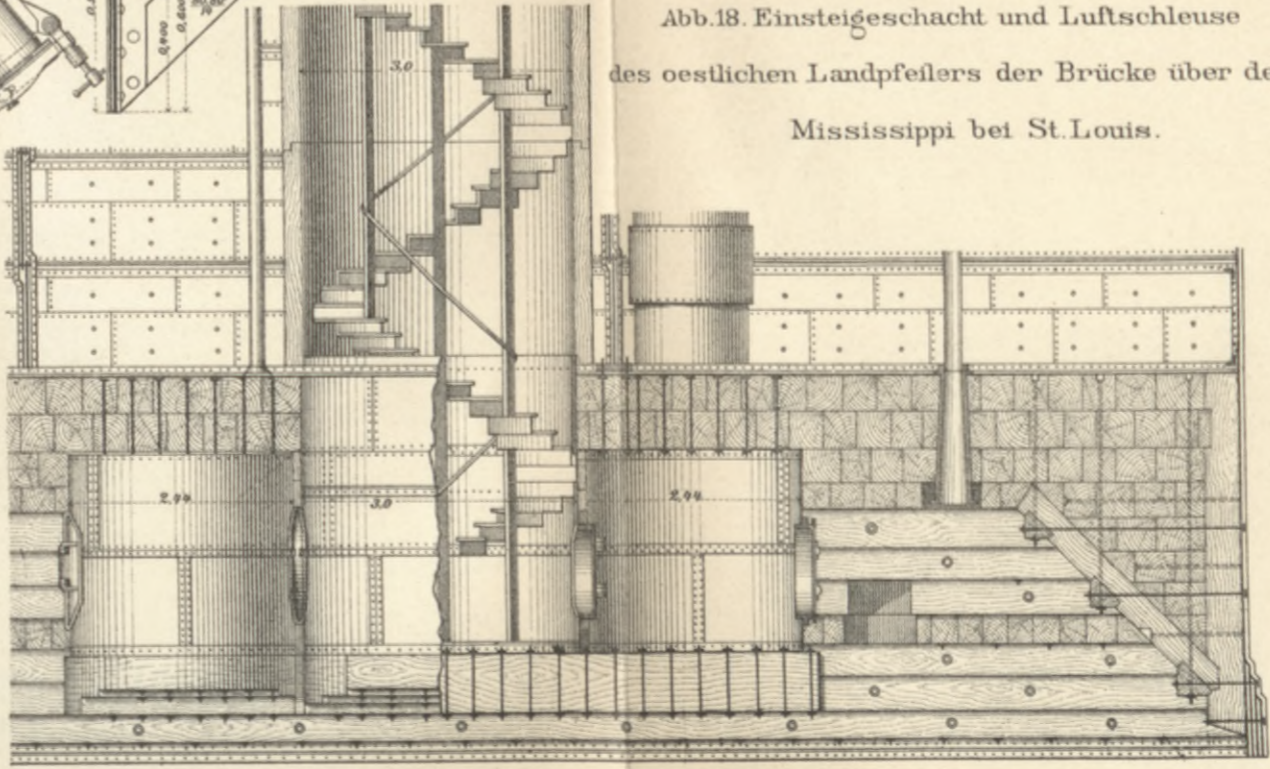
Einsteigeschacht und Luftscheuse des oestlichen Landpfeilers der Brücke über den Mississippi bei St. Louis.
